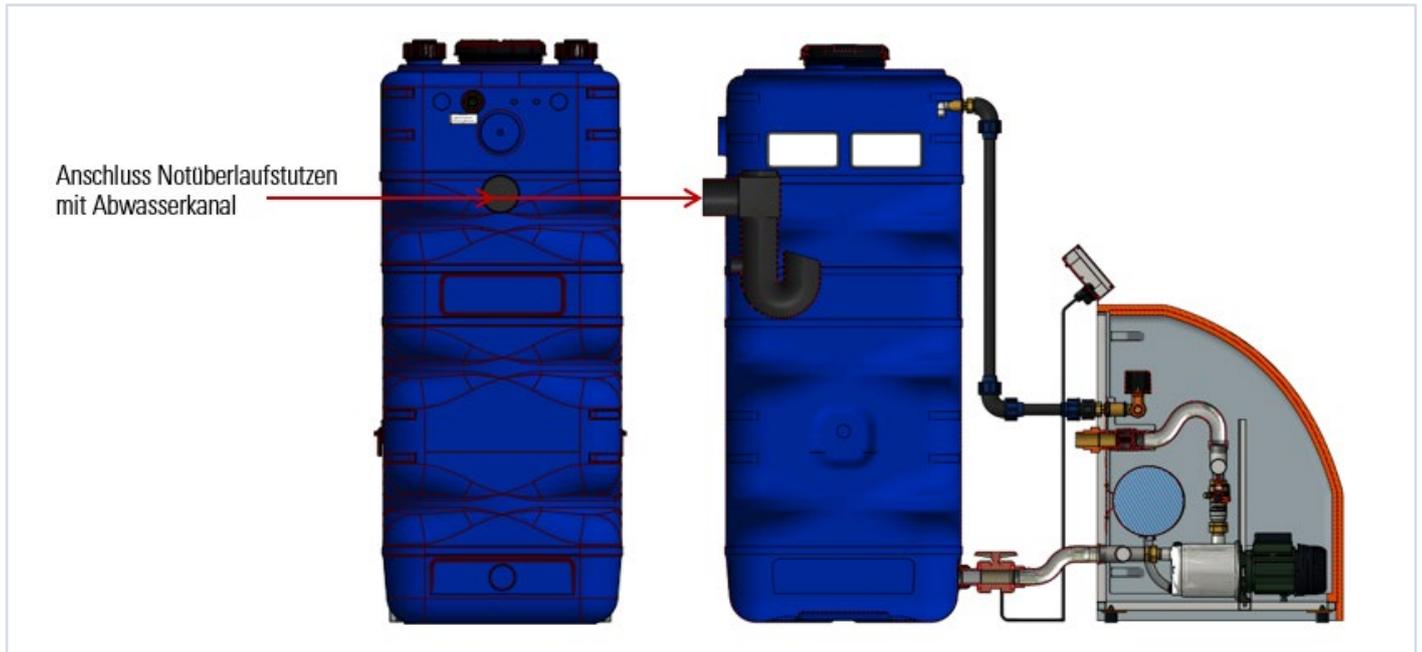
Notüberlaufanschluss mit einer Trinkwassernachspeisung
